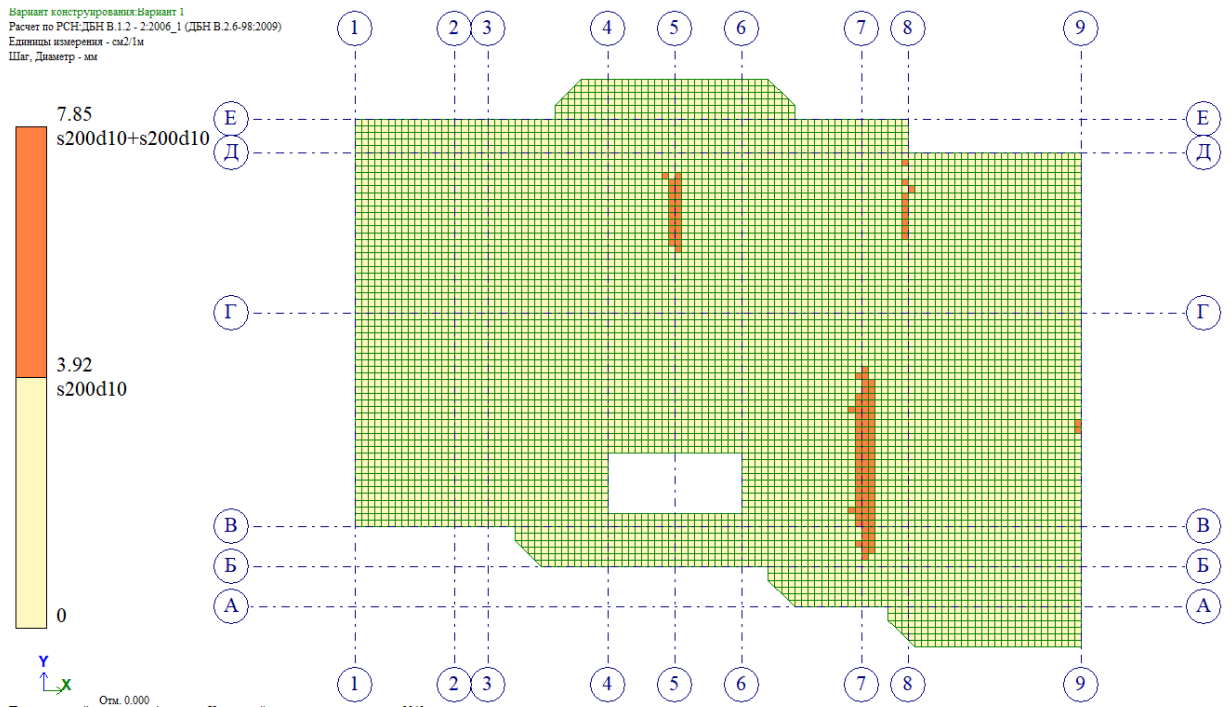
Армування плити перекриття по верхній грані вздовж осі X
